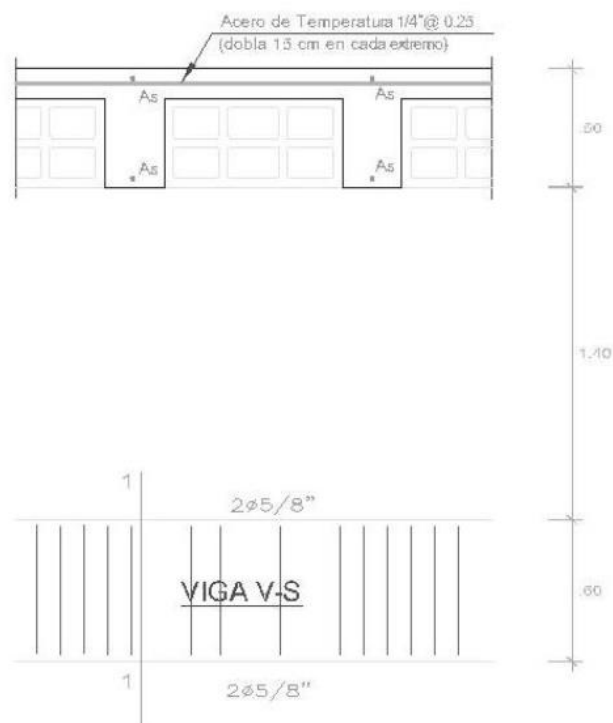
Detalle de viga, Fuente: Elaboración Propia
